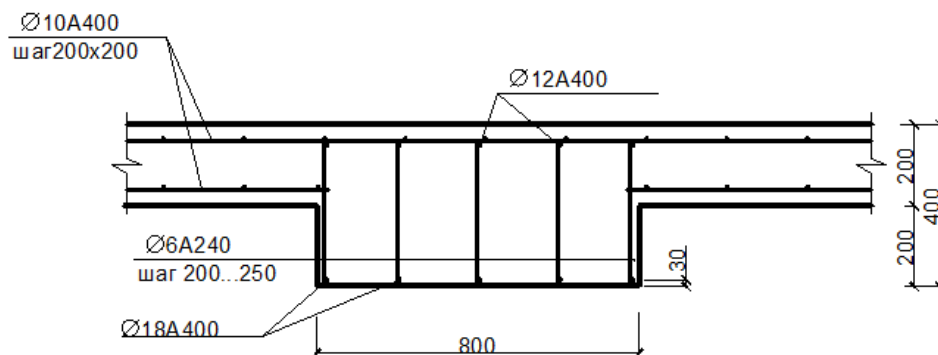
Сечение балки монолитного перекрытия и ее армирование
